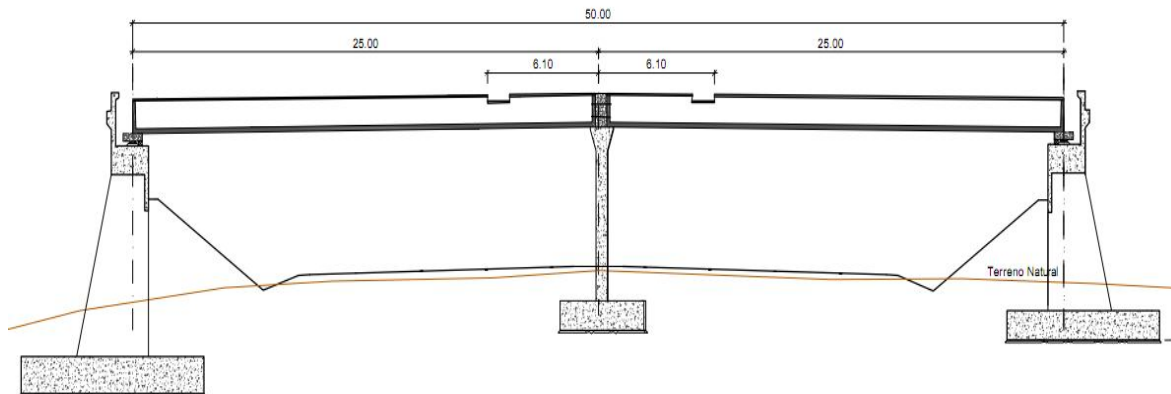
Excerto do faseamento Construtivo, Fonte: Edgar Cardoso Laboratório de Estruturas
